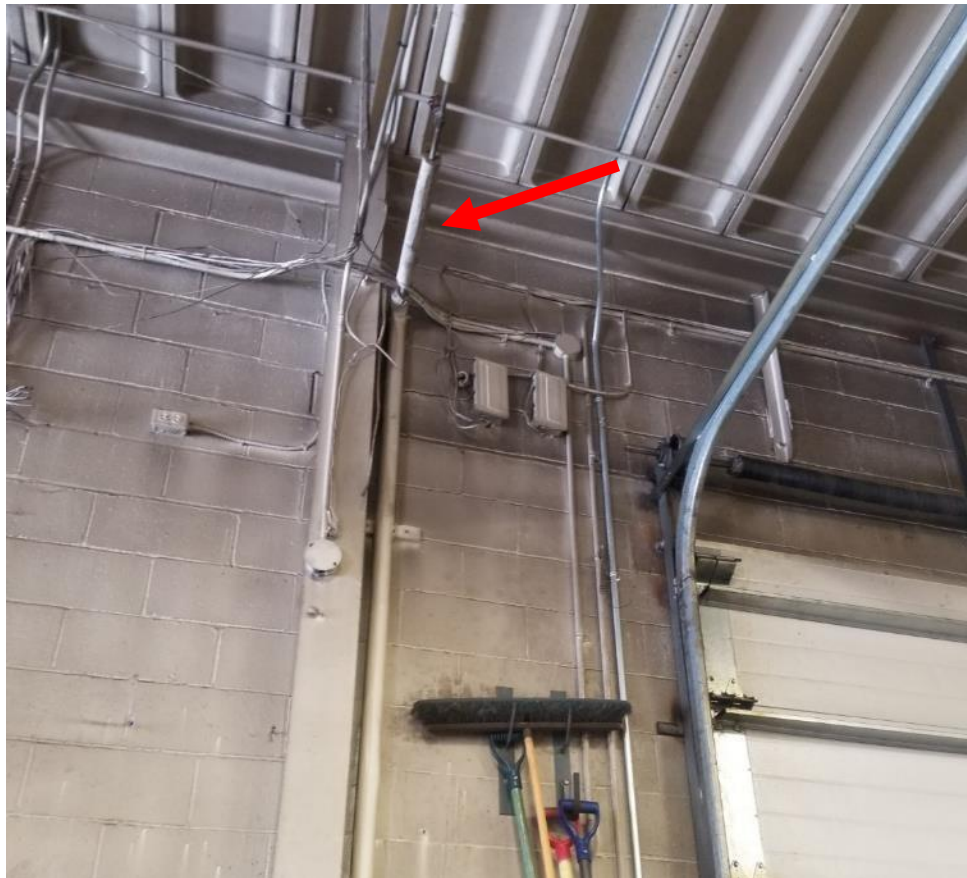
Rez-de-chaussée, local d'entretien, mur ouest adjacent aux portes de baie, 1 mètre linéaire d'isolant alvéolaire en mauvais état.
